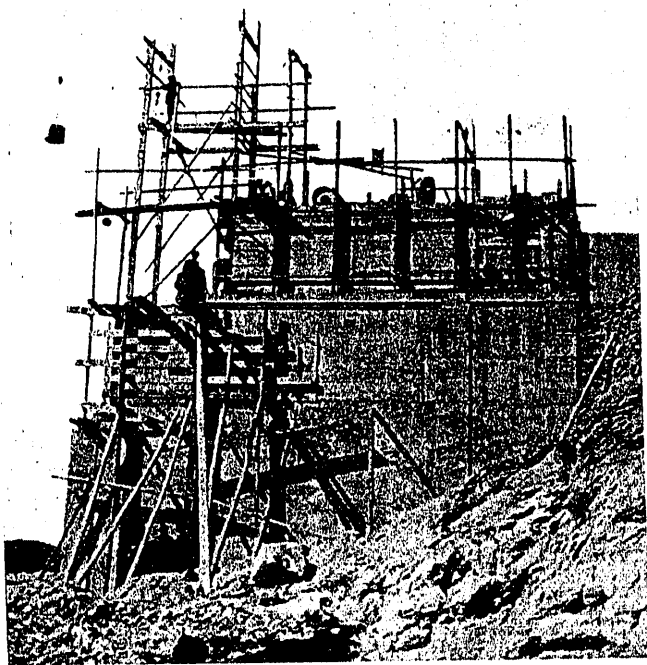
Construcción del estribo derecho y transbordador de hormigón para el otro estribo
